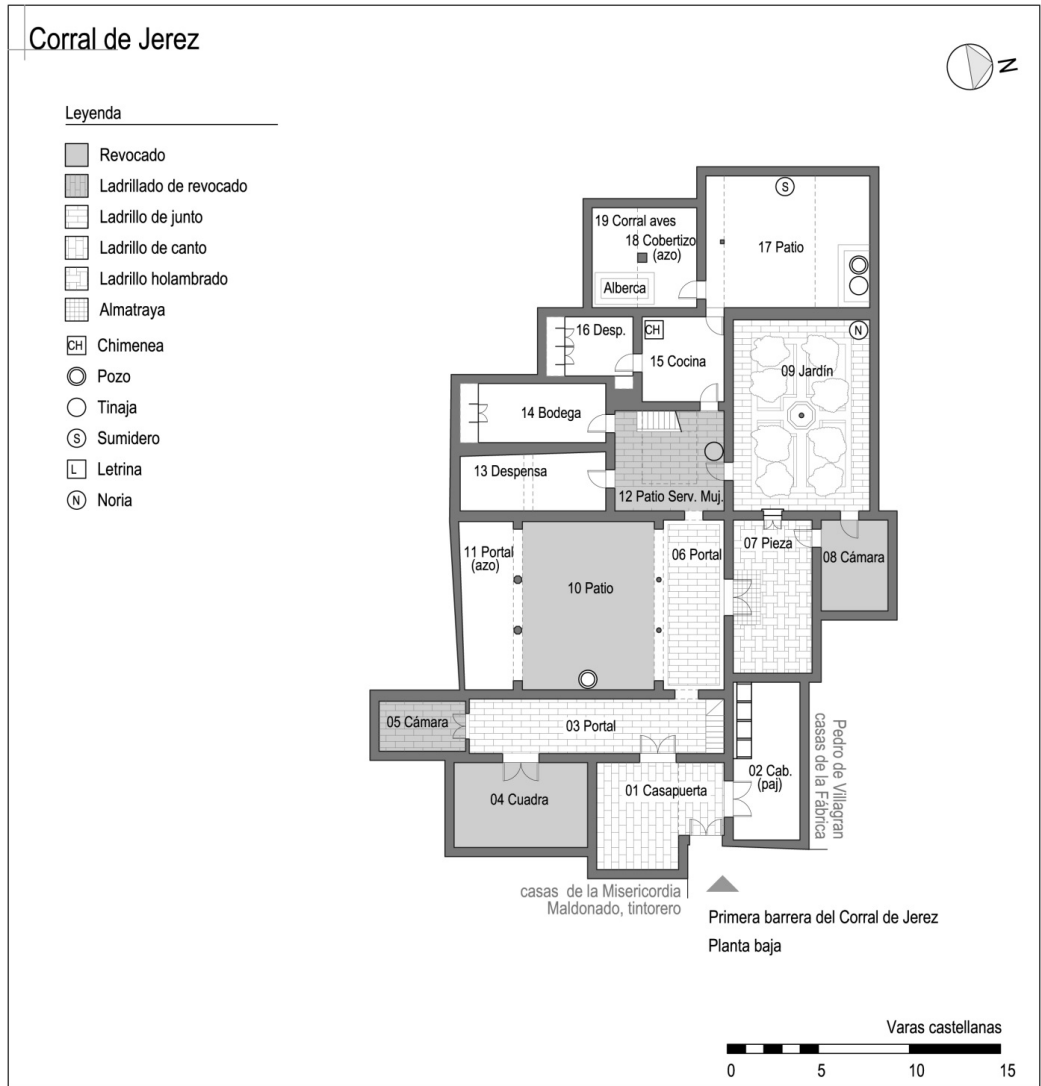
Planta baja de la casa en Corral de Jerez [Fuente: La autora].
